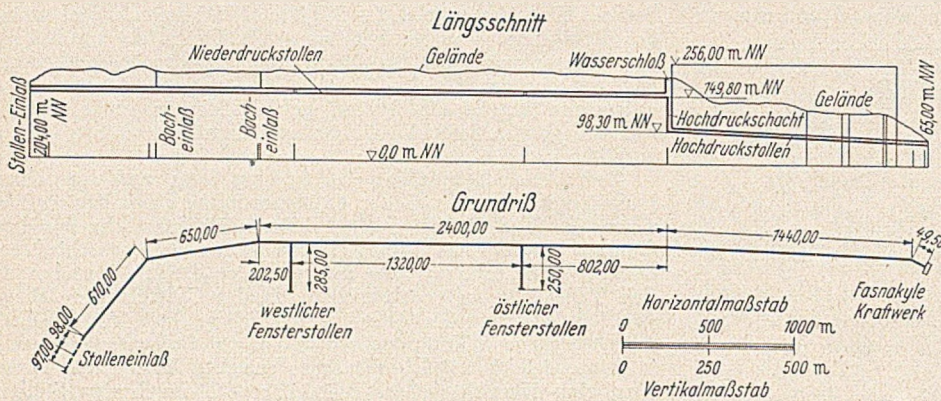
Längsschnitt und Grundriß der Stollenanlage von Beinn o'Mheadhoin nach Fasnakyle.
